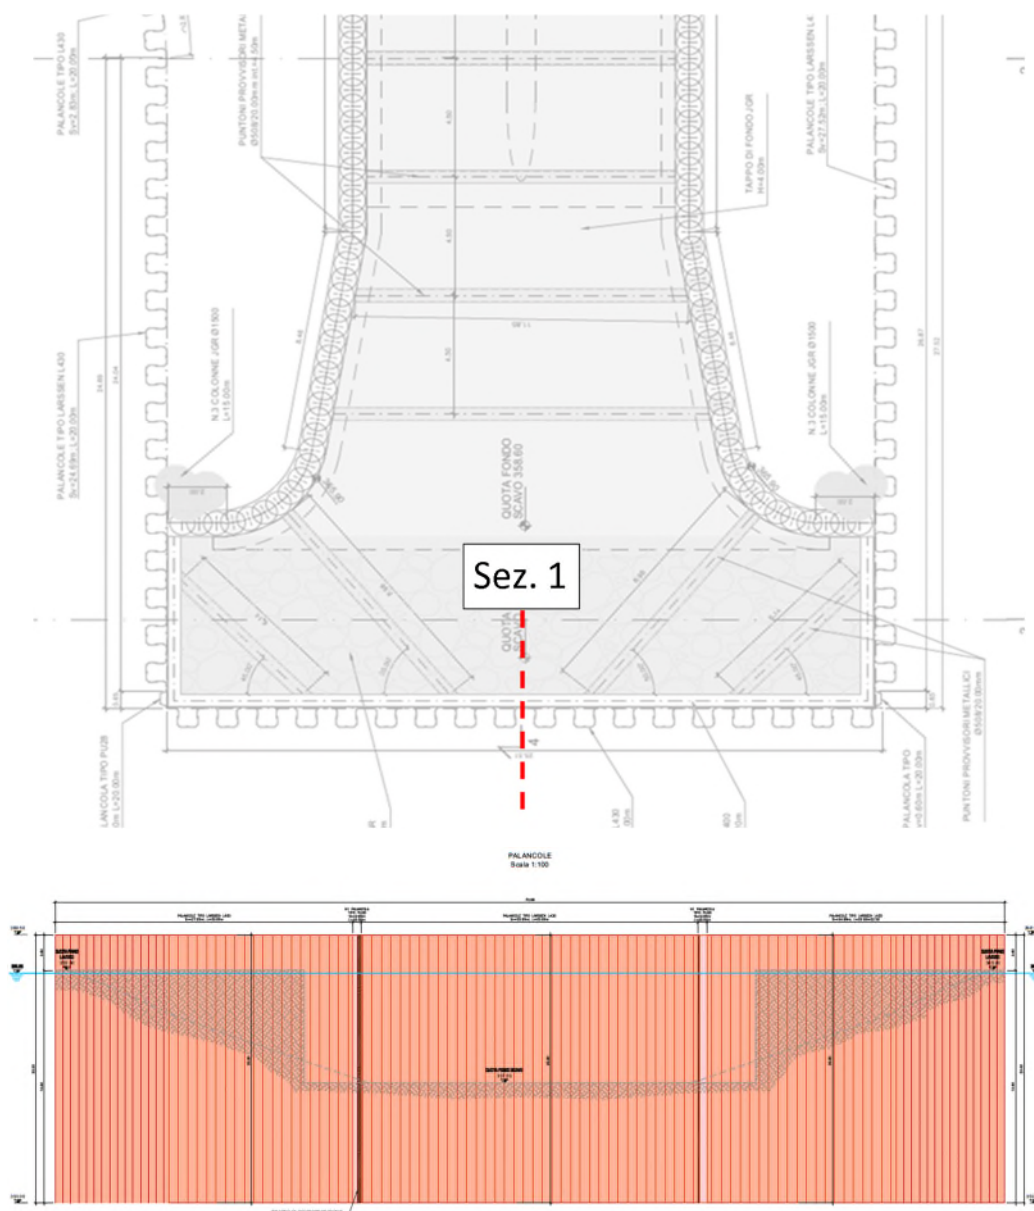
Palancole metalliche L430 – Pianta - viste e sezioni
